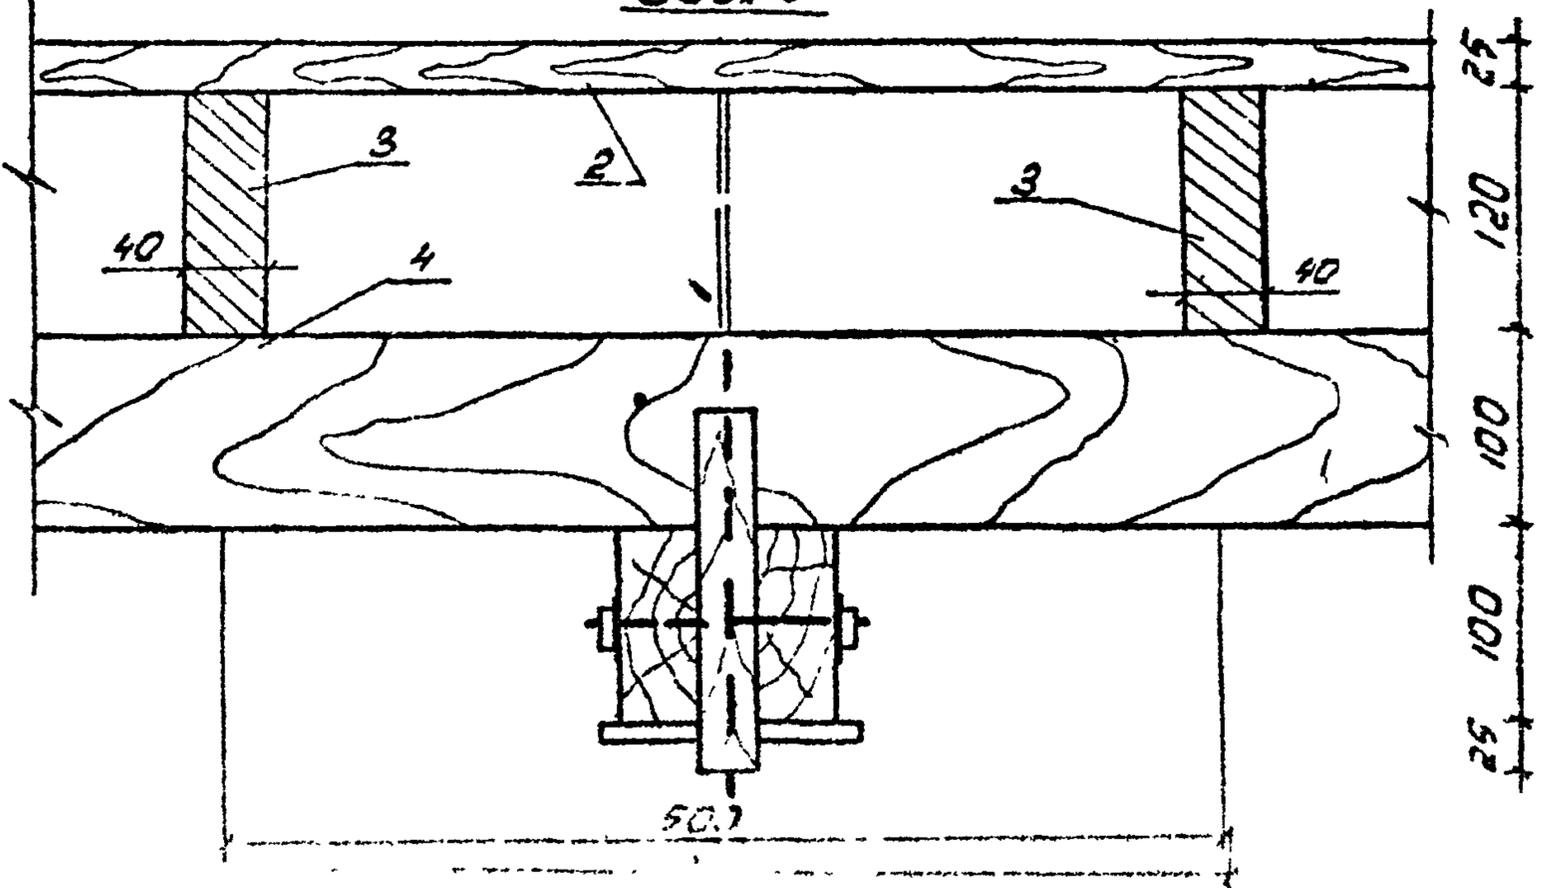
Узел "Б" Вариант по металлическим балкам перекрытия.
